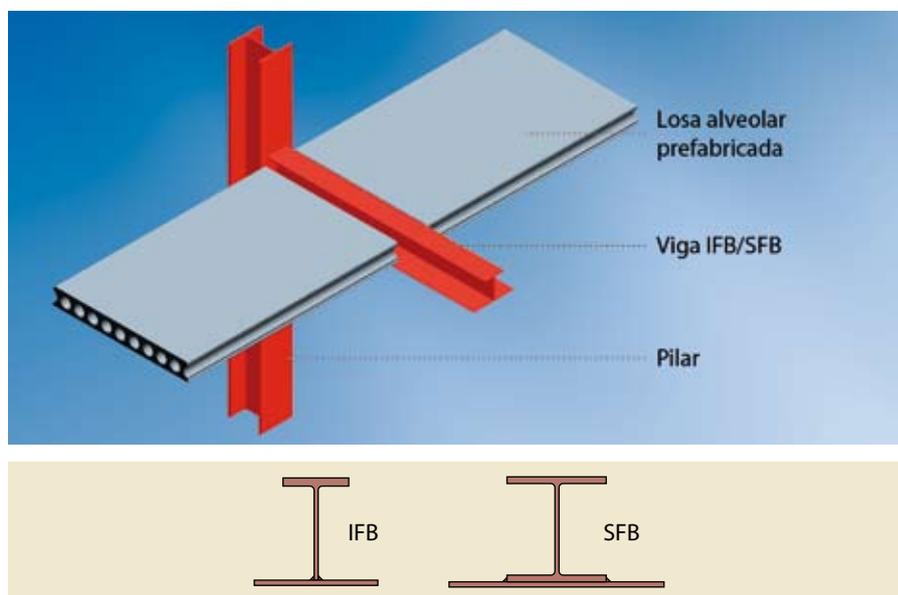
Forjado integrado con vigas asimétricas y placas de hormigón prefabricado
